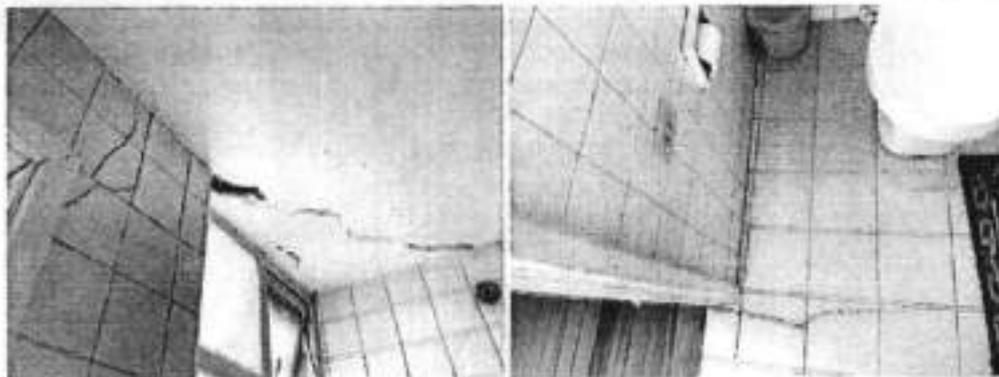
y 33. Grietas y fisura en vértices entre placa de entrapiso y fisura en vértices entre columnas y muros perimetrales del apartamento 201 predio P1.
